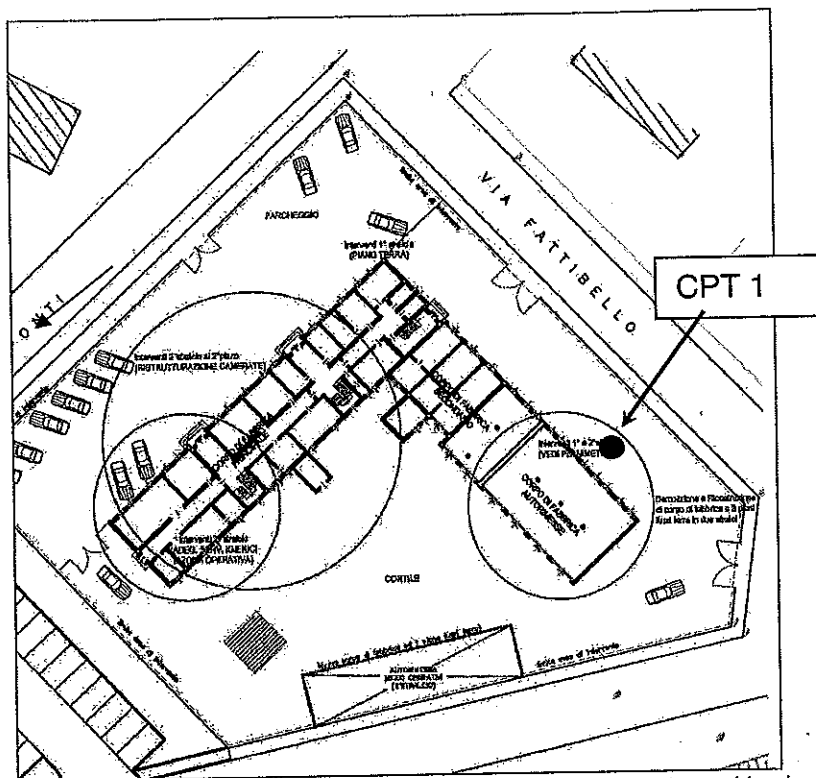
Planimetria generale del fabbricato, in evidenza le aree soggette a ristrutturazione; ubicazione prova CPT1/141-07
